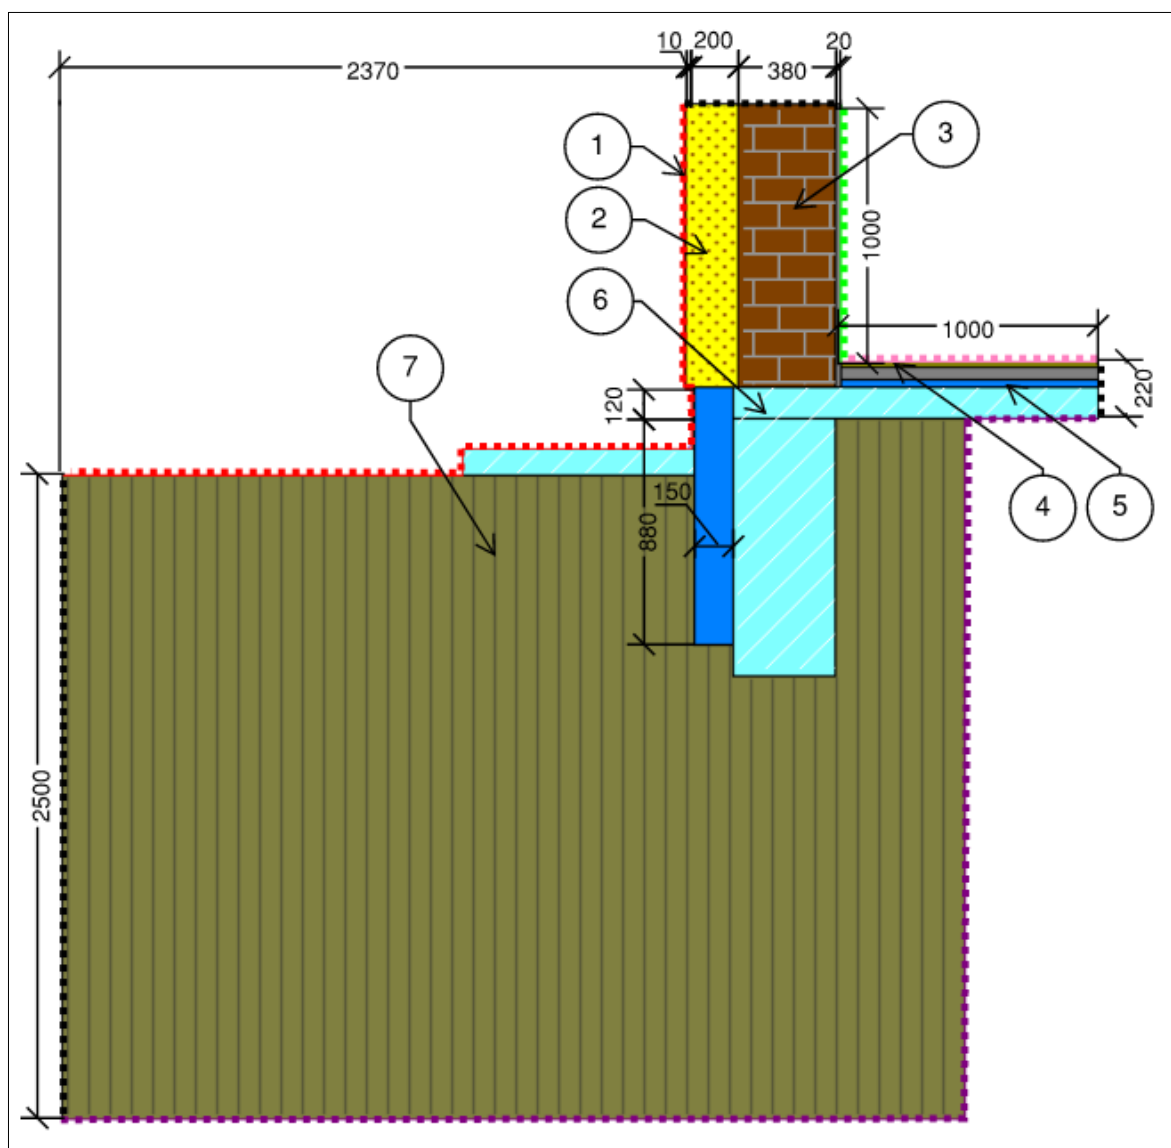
Схема покращеного вузла конструкції підлоги по ґрунту до зовнішніх стін з фасадною теплоізоляцією
